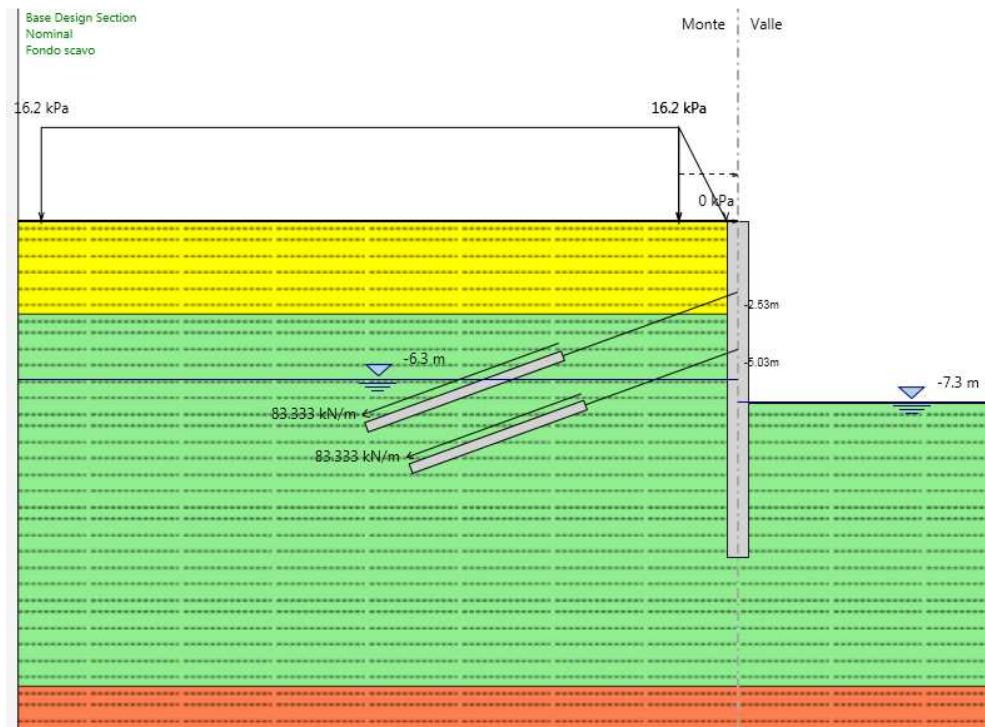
Sezione 2 - Modello di calcolo - step finale di calcolo (fase 6)
